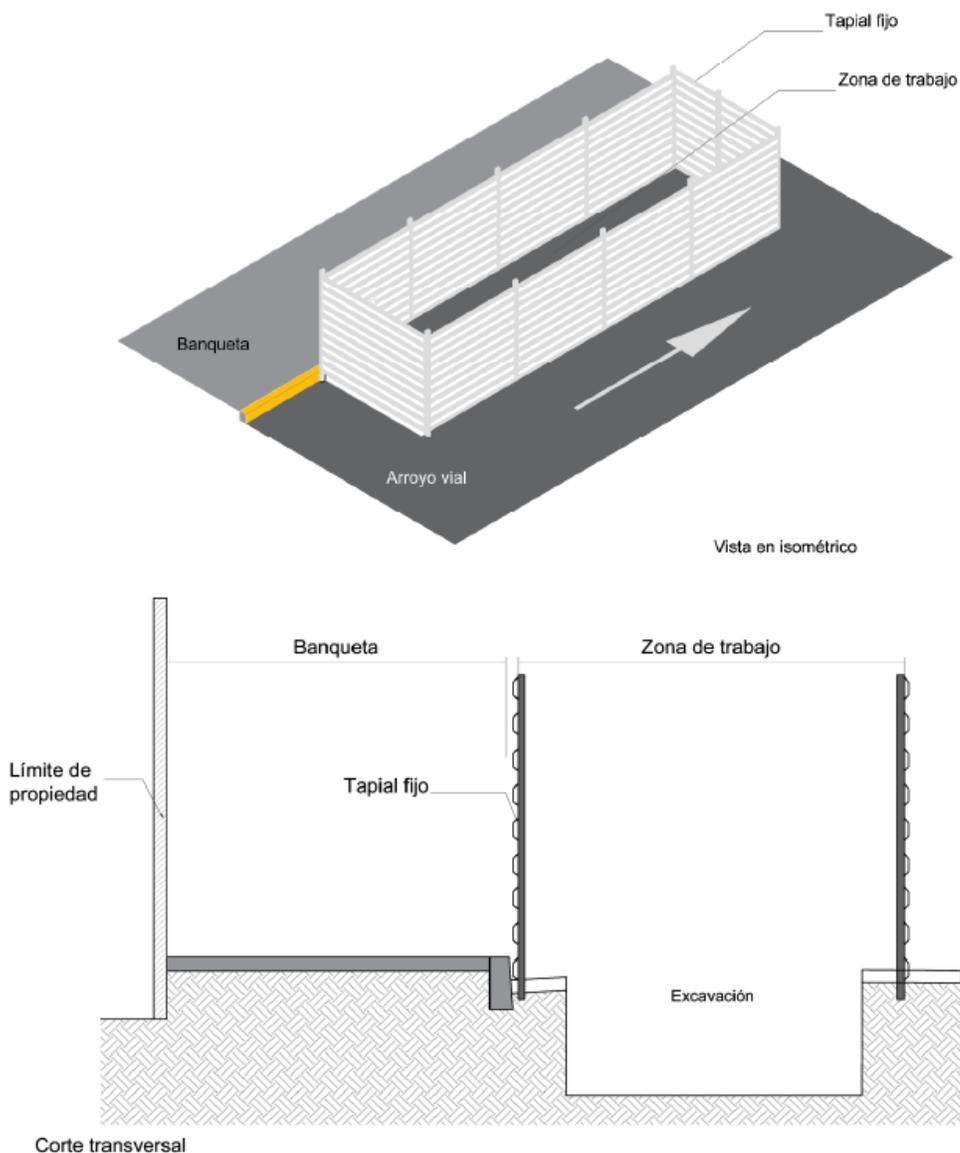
Tipos de acordonamiento en zonas de obra, con estructura fija
